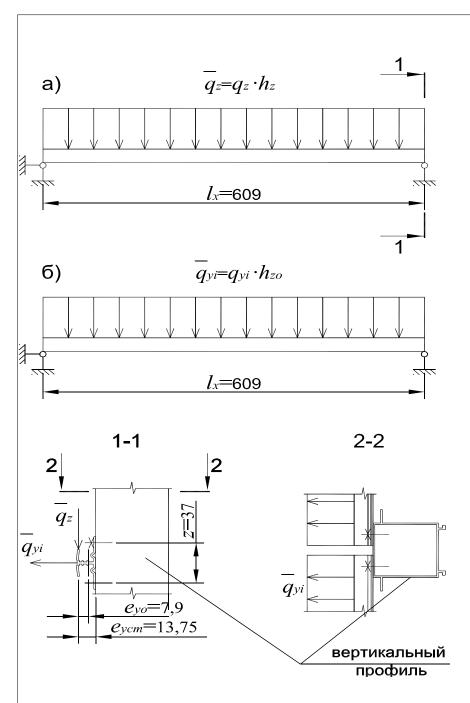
Расчетные схемы горизонтального профиля а - на вертикальные нагрузки; б - на ветровые нагрузки.
